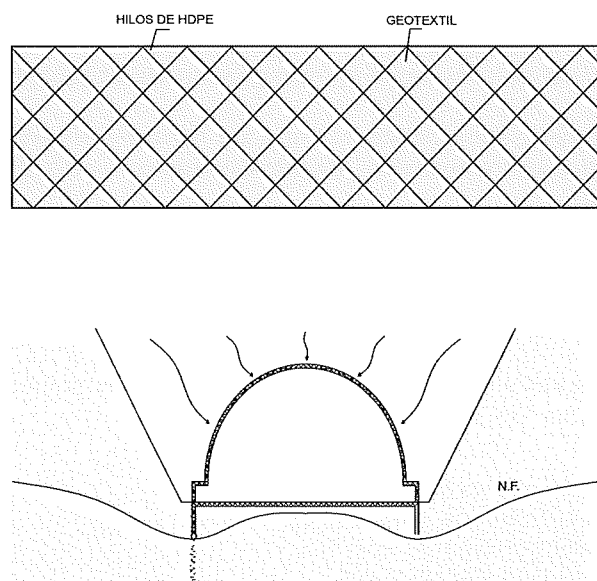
Geocompuesto con georred drenante. Detalle y sección tipo de falso túnel.
